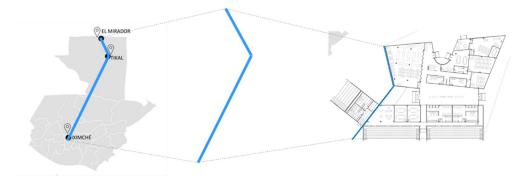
, Elaboración propia – llustración y planta arquitectónica (Luis Cifuentes 2023)
